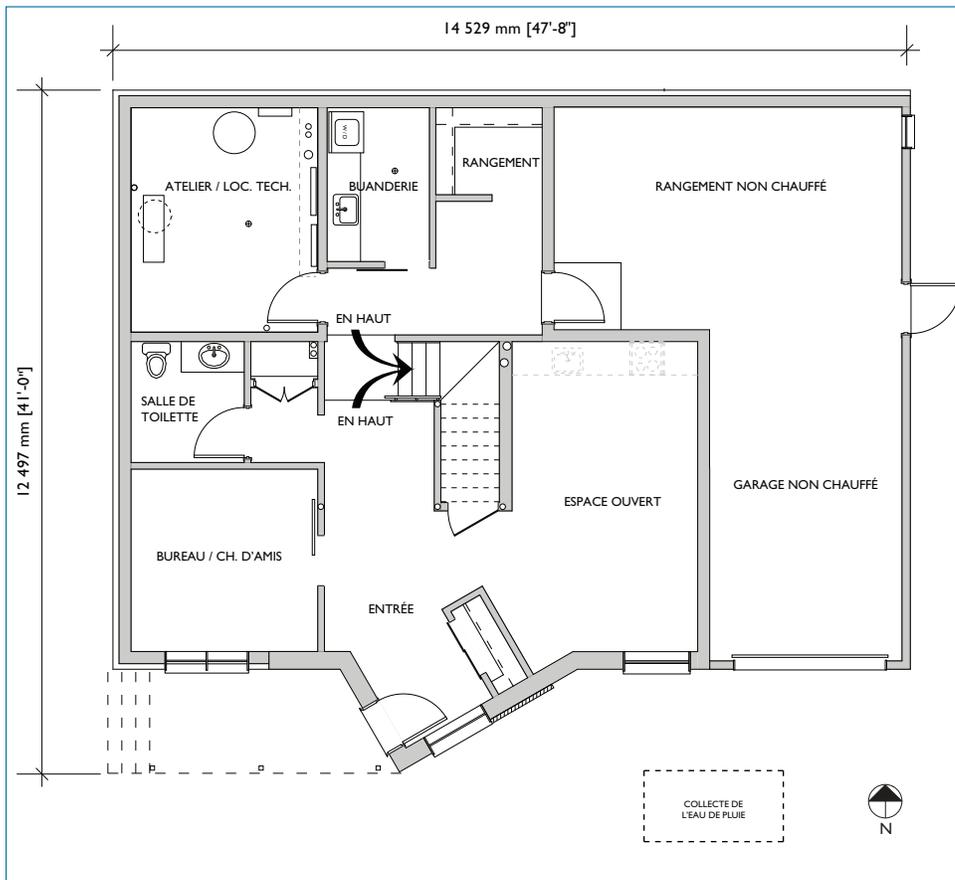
Plan du niveau inférieur de la maison EQUilibrium^{MC} EchoHaven
